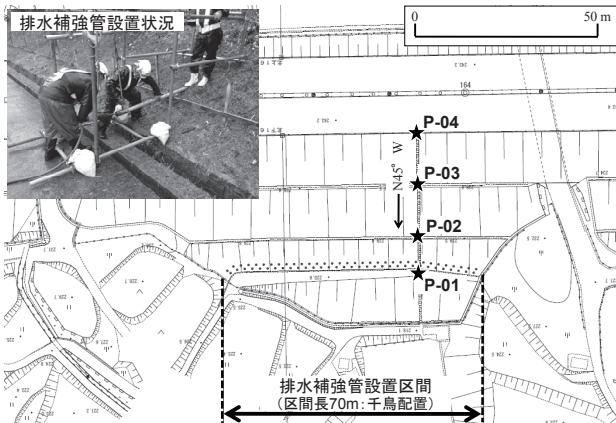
対象盛土での排水補強パイプの打設状況(平面図)
